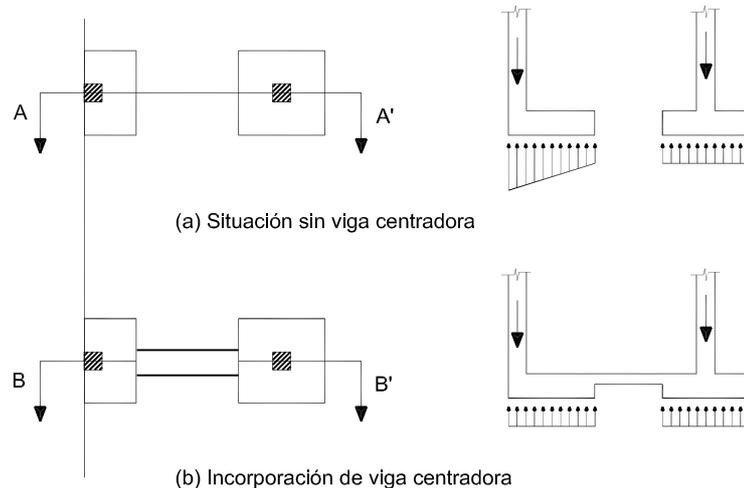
Ejemplo del empleo de vigas centradoras para redistribución de presiones sobre el terreno
